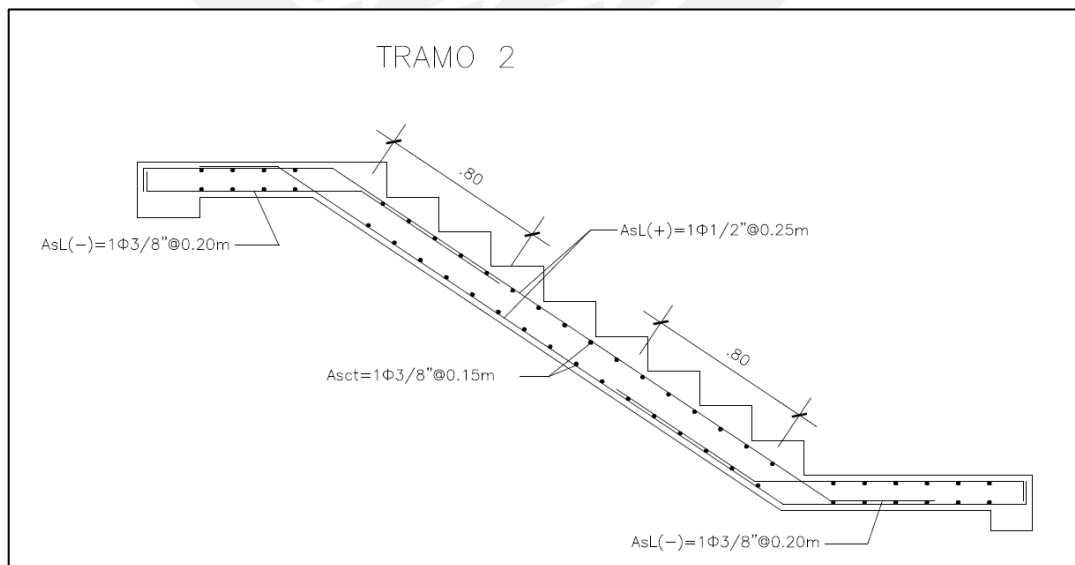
Detalle de acero del Tramo 2 de escalera.
